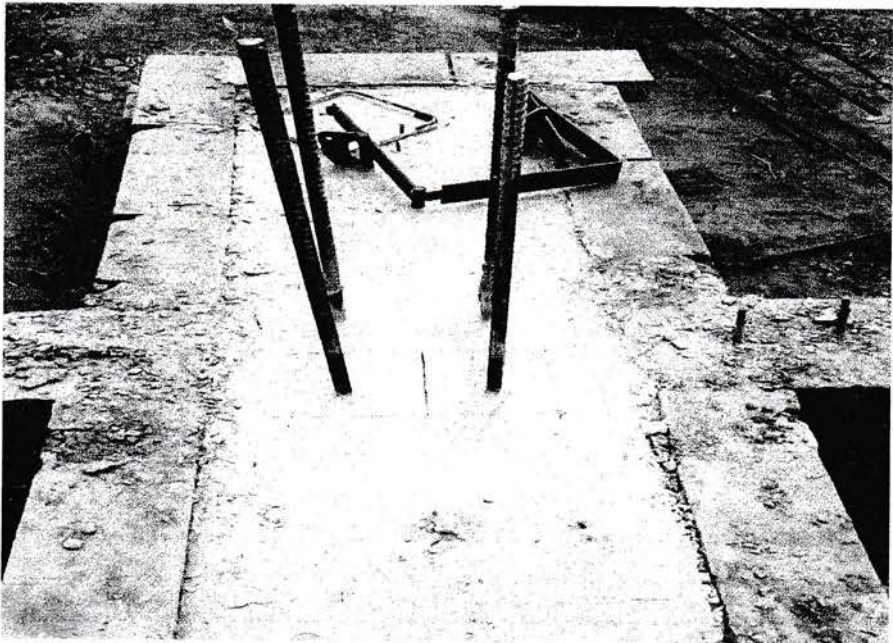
Pondasi pile cap yang diberi penulangan.
